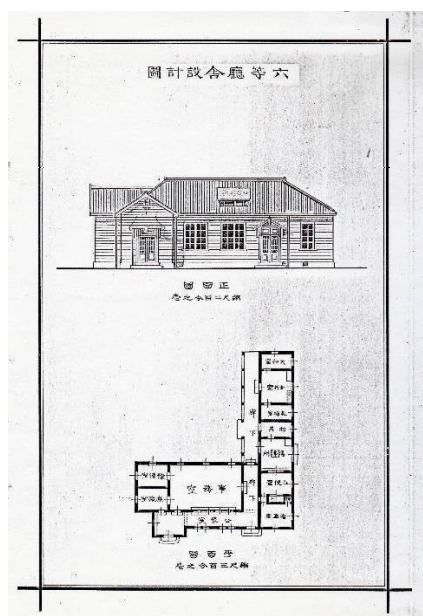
6等庁舎設計図 図-5.1.2 7, 8等庁舎設計図
